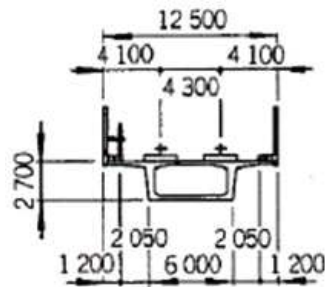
Dai-San Mabuchi-gawa Bridge-연속상로아치교(Japan)
